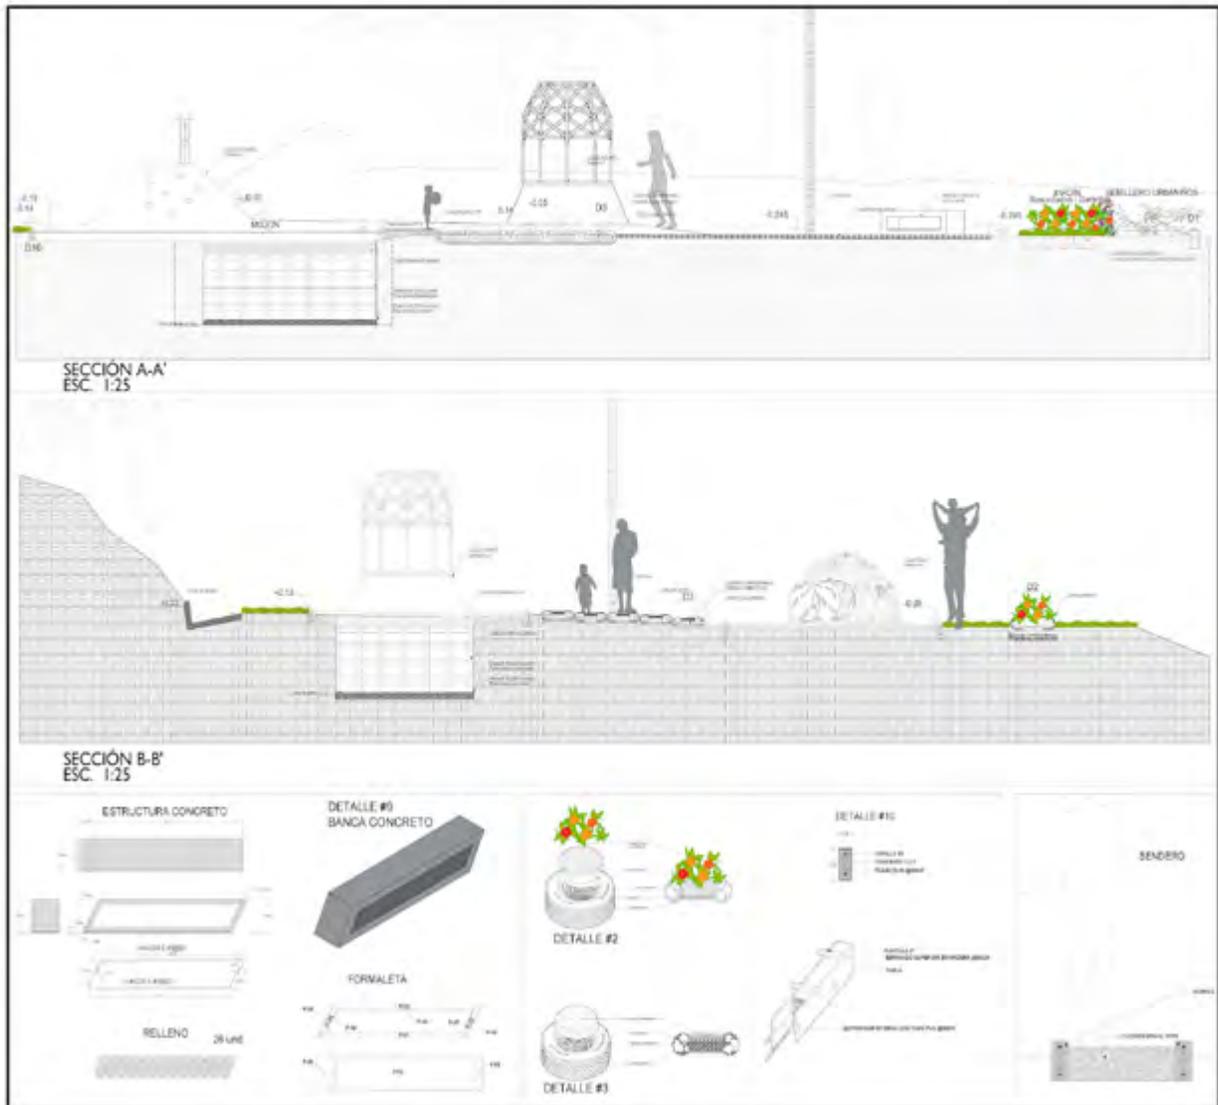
Plano cortes y detalles constructivos de las unidades “Los Bichos” en la cancha de Los Canasteros, de Siloé, Cali.
